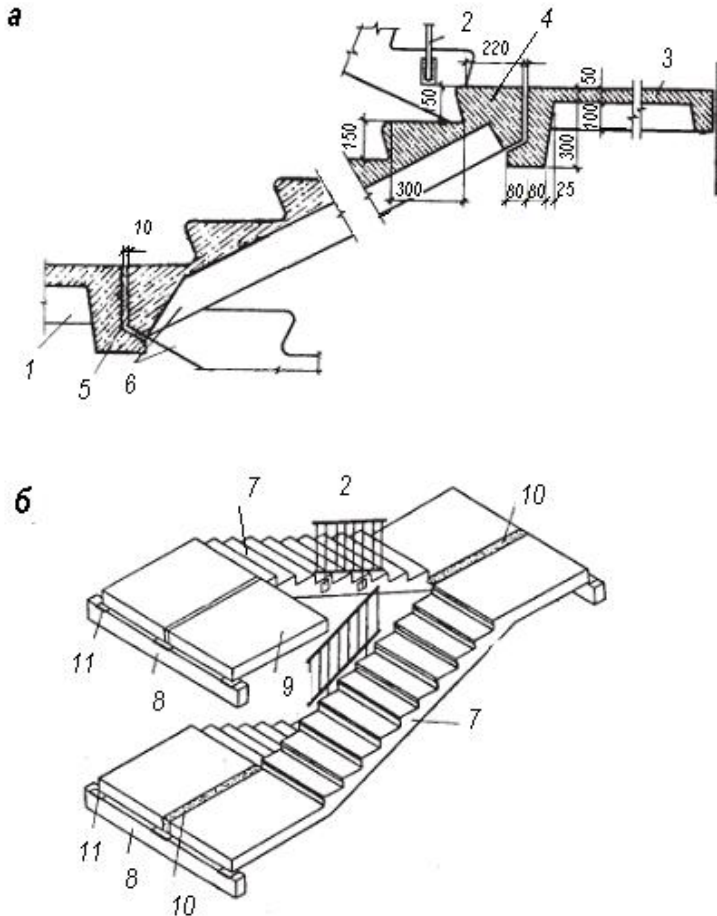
Сходи з великорозмірних елементів: а – з площадок і маршів ребристої конструкції; б – із маршів з двома напівплощадками; 1 – поверхова площадка; 2 – огородження; 3 – міжповерхова площадка; 4 – фризовий східець; 5 – цементний розчин; 6 – сходовий марш; 7 – сходовий марш з напівплощадками; 8 – ригель; 9 – додаткова плита – площадка верхнього поверху; 10 – заробляння бетоном; 11 – закладна деталь
